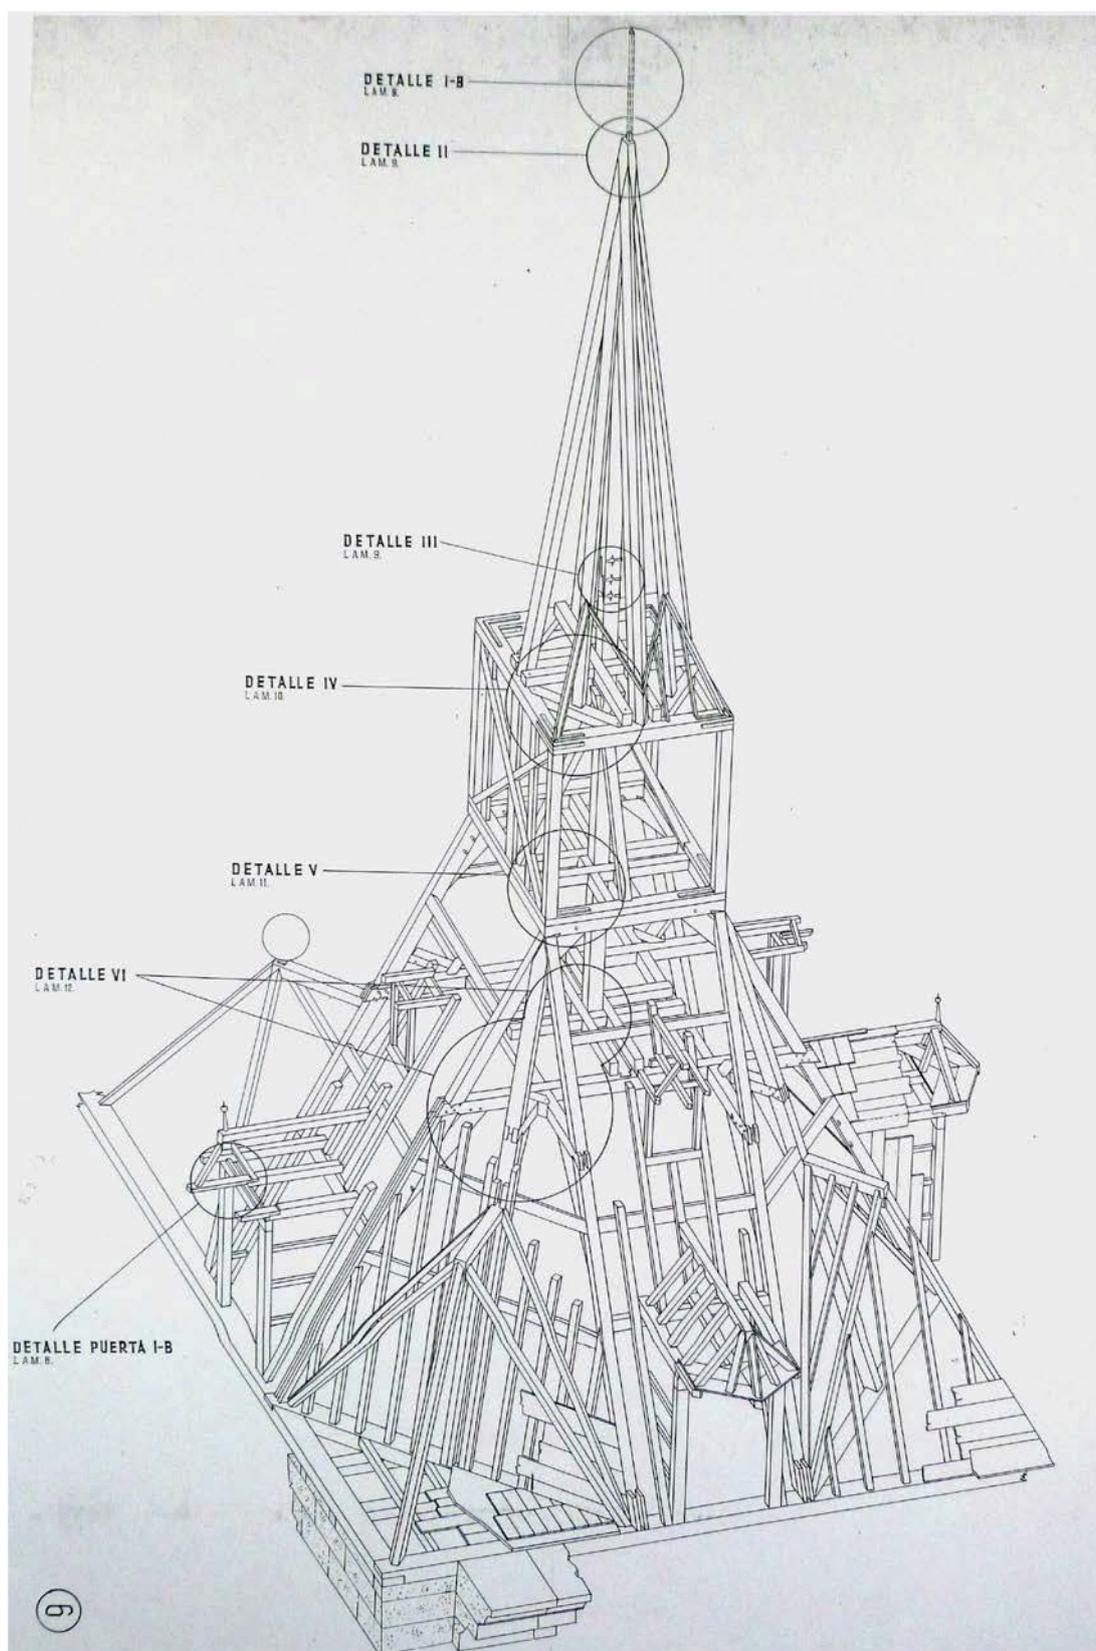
Perspectiva de la armadura del chapitel de las Damas, según levantamiento realizado por Julio Vidaurre entre 1963 y 1965. A.D.A.P.N. Plano 414
